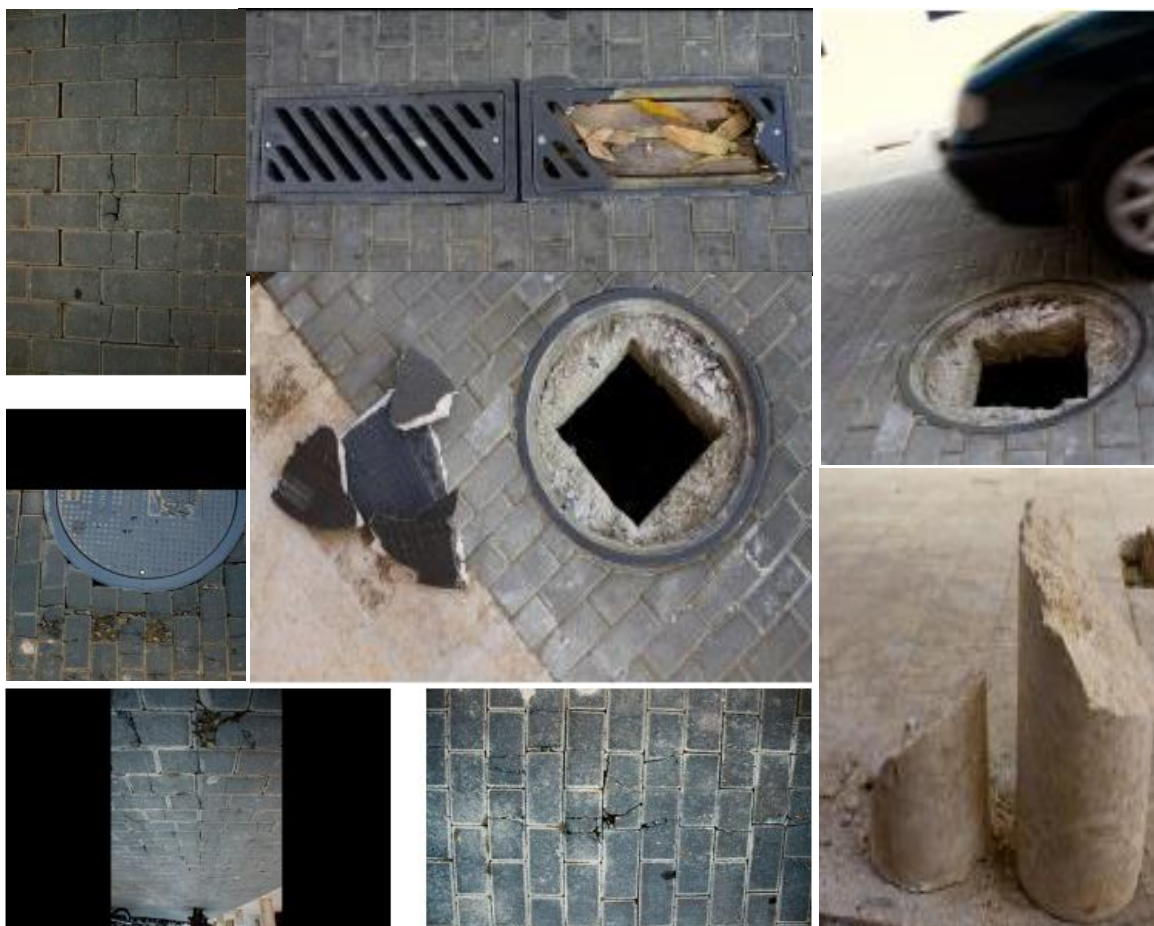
Situación alarmante de la circulación, alcantarillas sin tapas, adoquines agrietados. Fuente: Las fotografías realizadas por Manolo Vidal, residente en el sector (2014)
